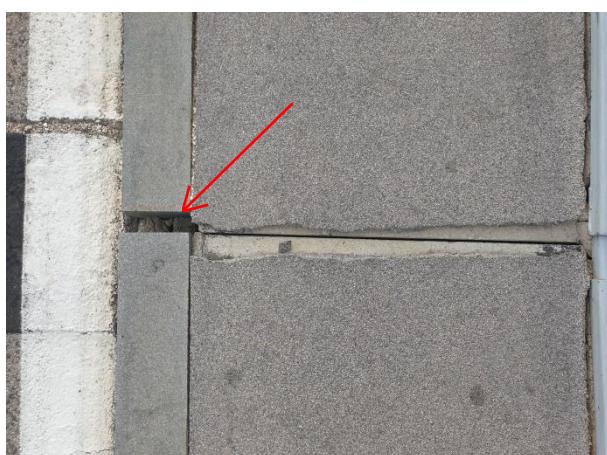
Loše postavljeni rubnjaci u krivini. Stupanj oštećenja S4.
